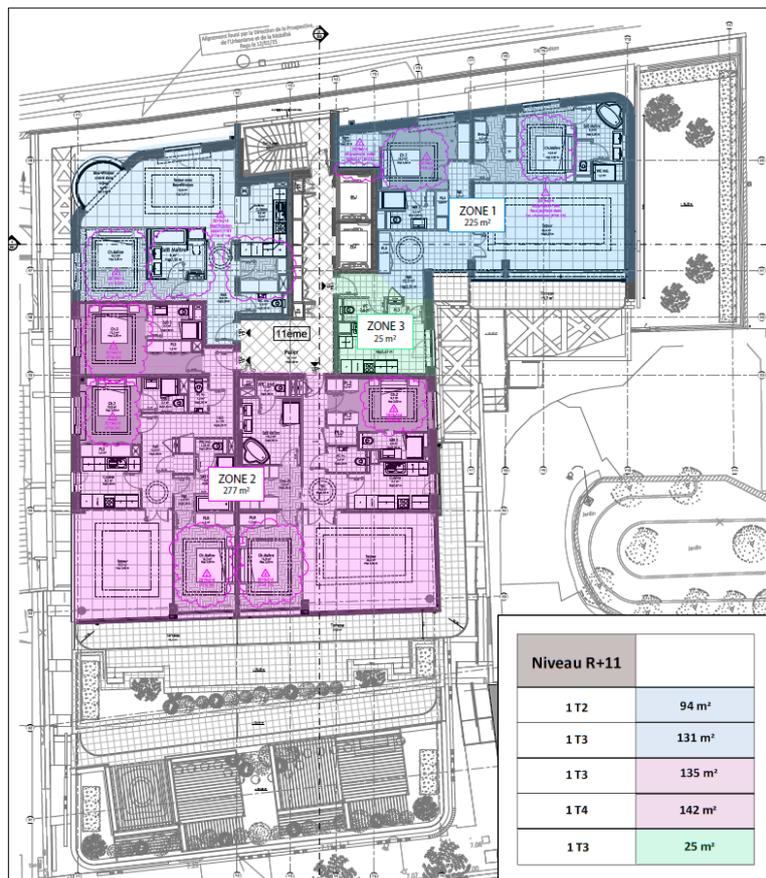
Divisione delle aree di lavoro dell'undicesimo piano (R+11)
